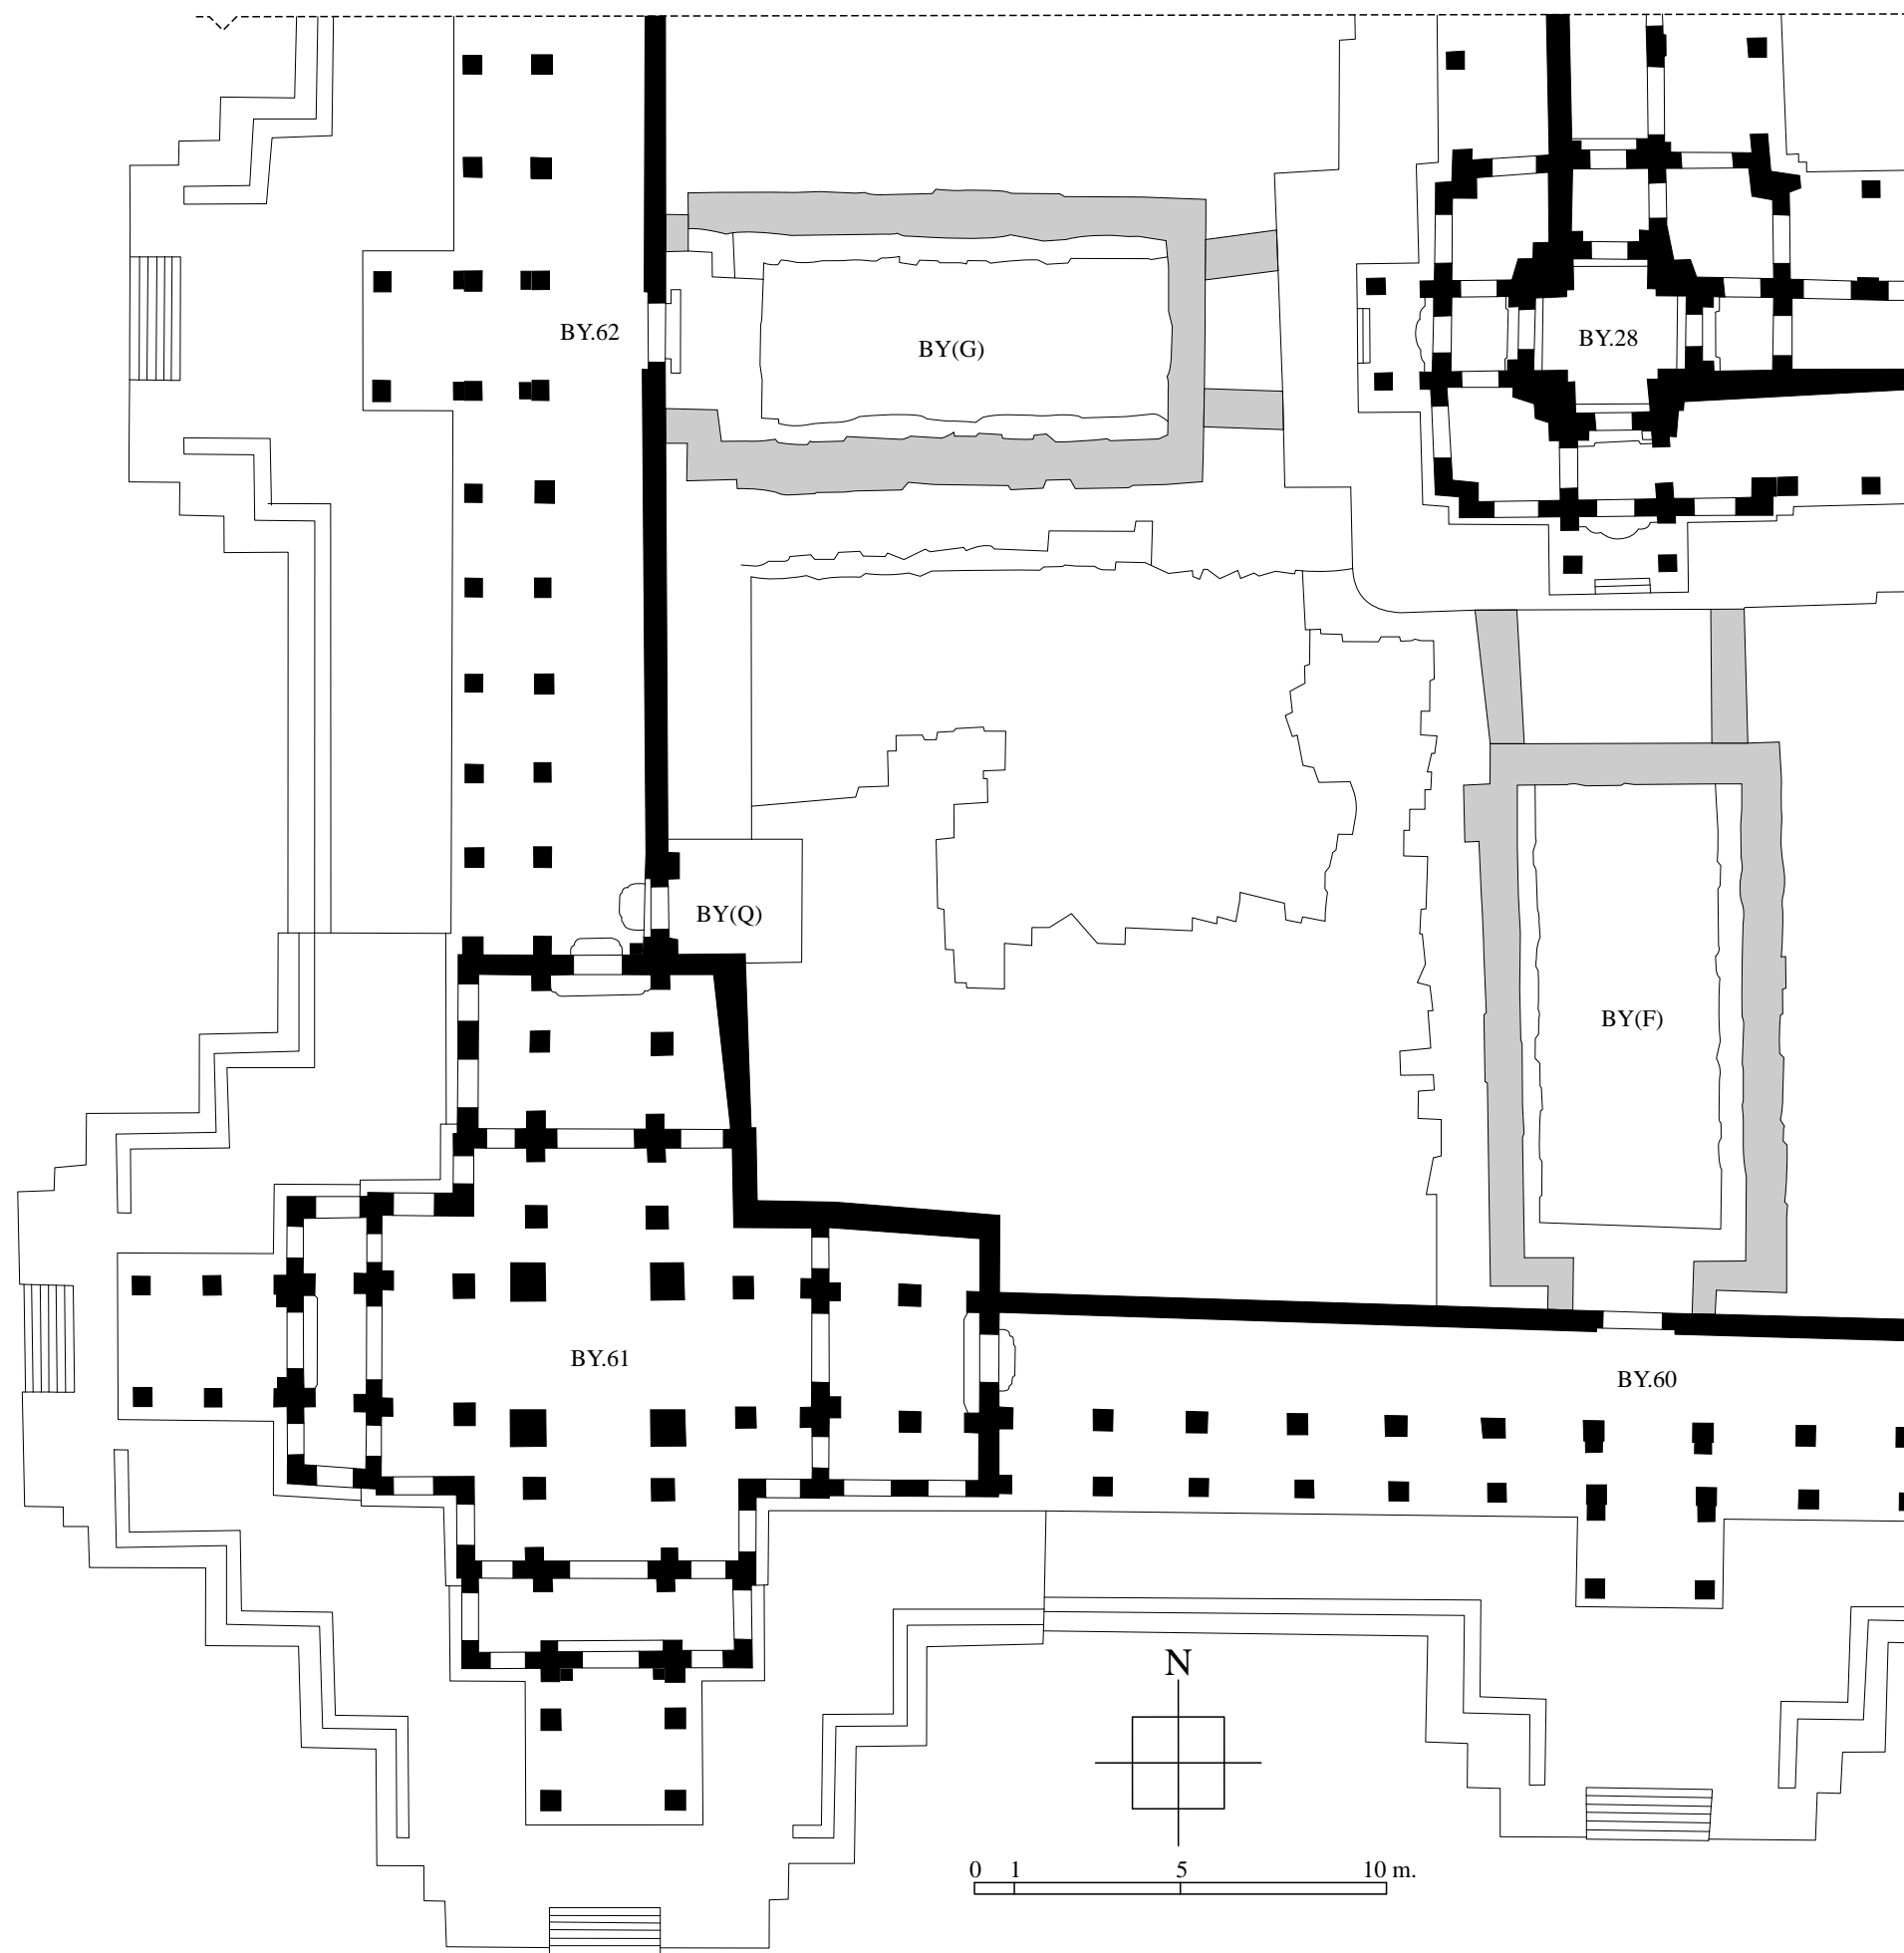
Plan du quart Sud-Ouest du Bayon
